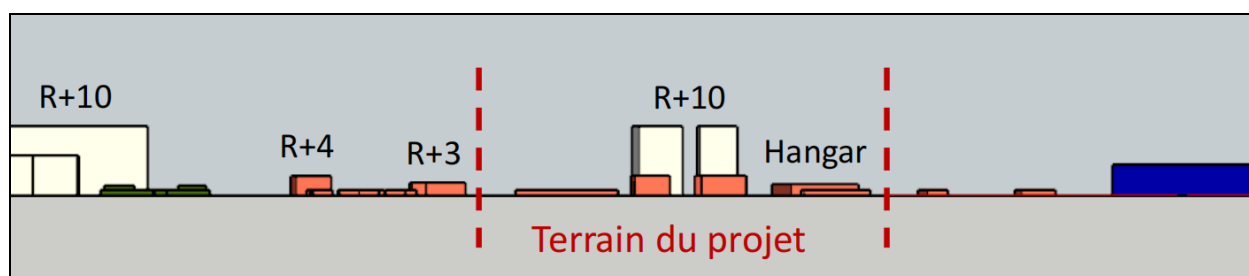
Coupe schématique longitudinale du site d'intervention, *source : Traitement personnel
